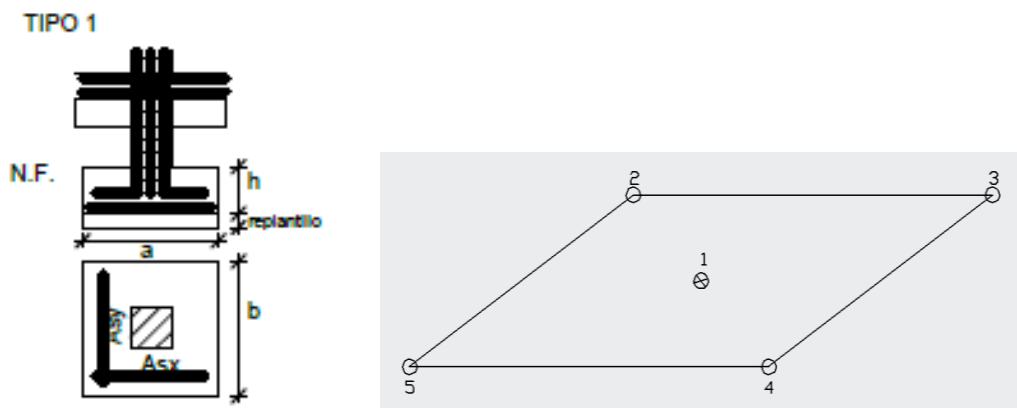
Zapata tipo 1 (central) y puntos de deformación.
